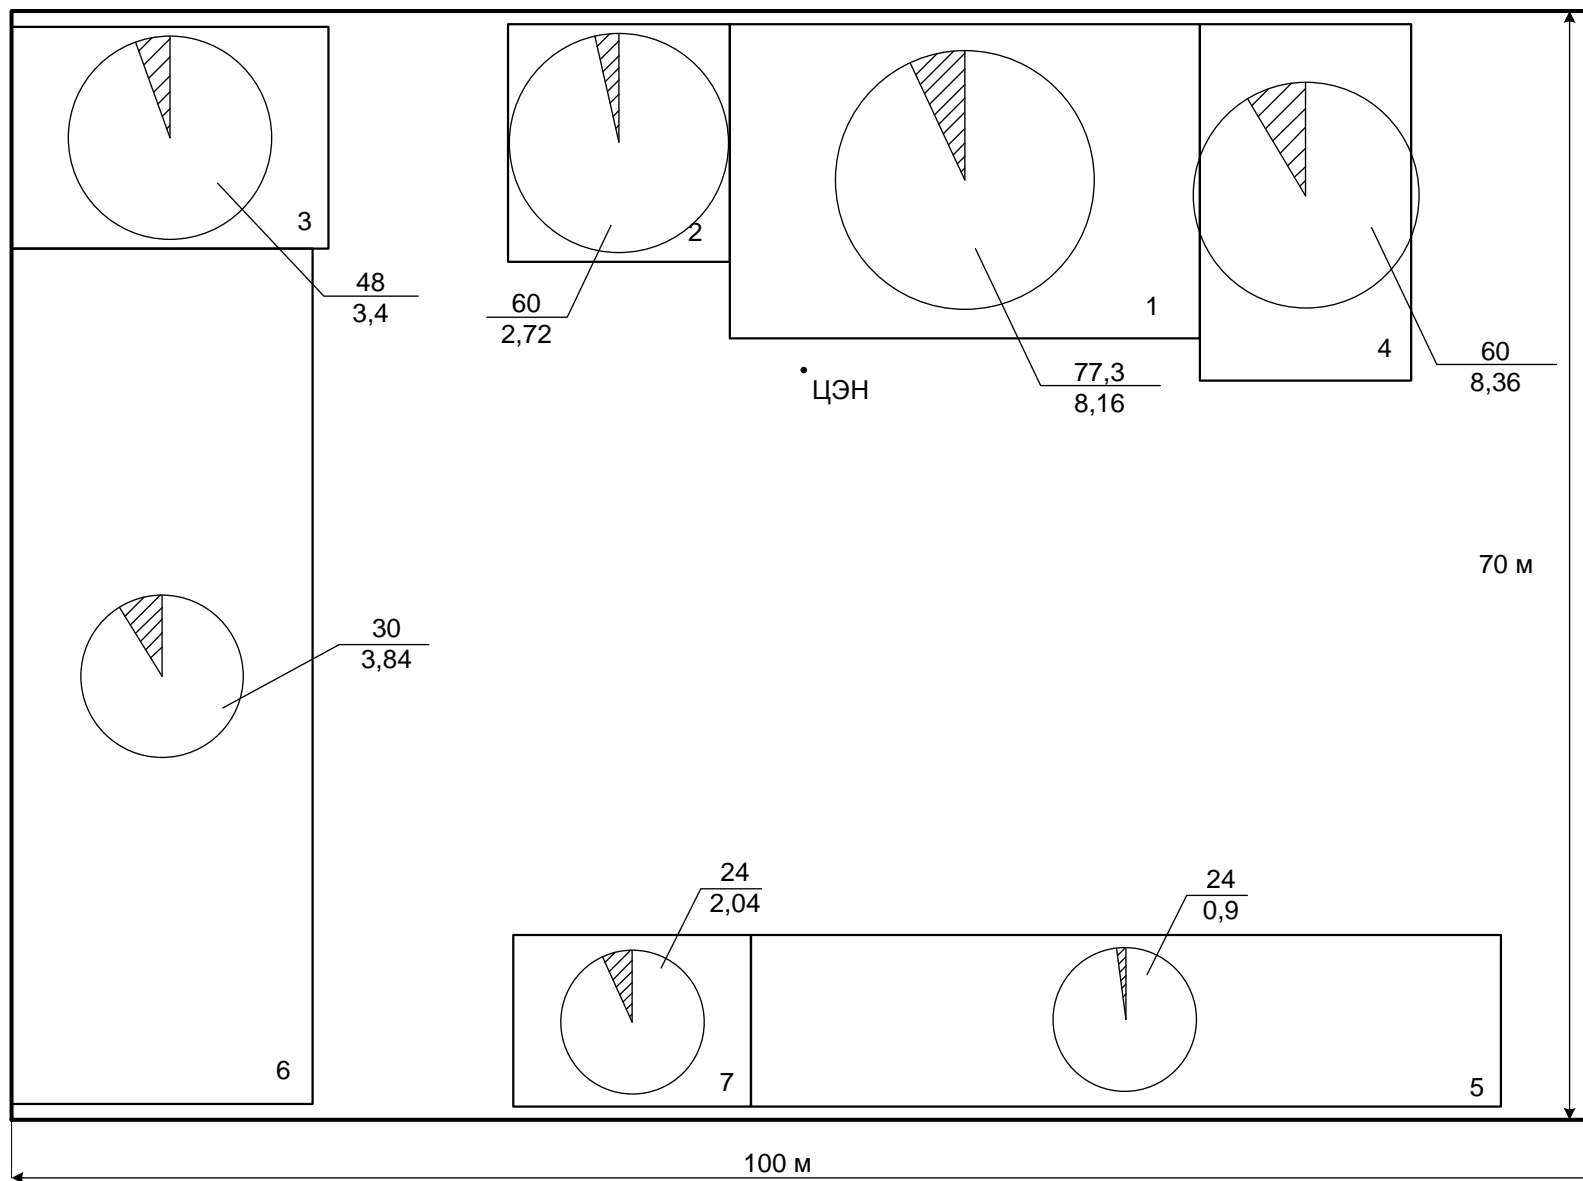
Генплан ООО «Кемеровоэлектромонтаж» с картограммой нагрузок
